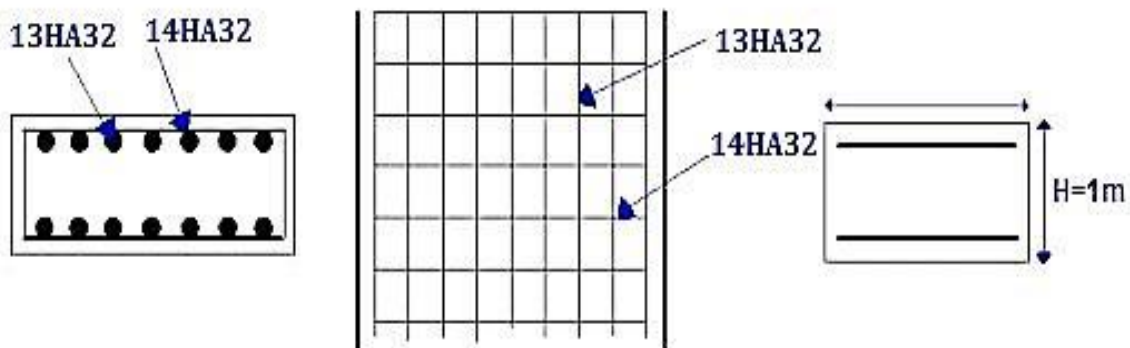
Croquis du ferrailage de la pile (voile).
